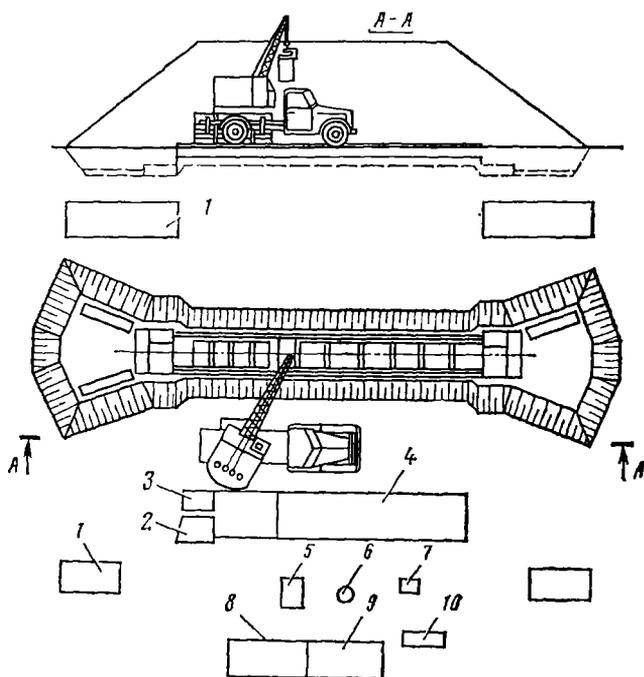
Схема монтажа фундамента и тела трубы краном К-61:
